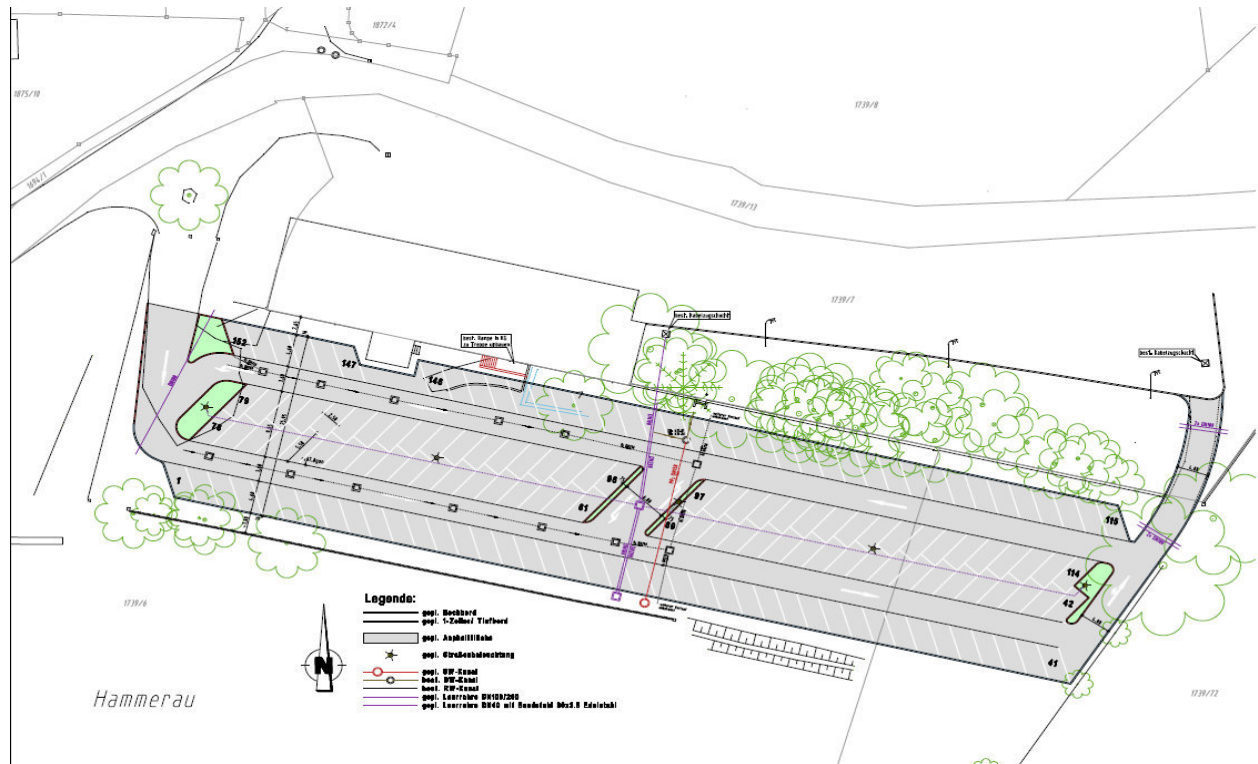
Lageplan Parkplatz Stahlwerk Annahütte (Quelle: Stahlwerk Annahütte)
